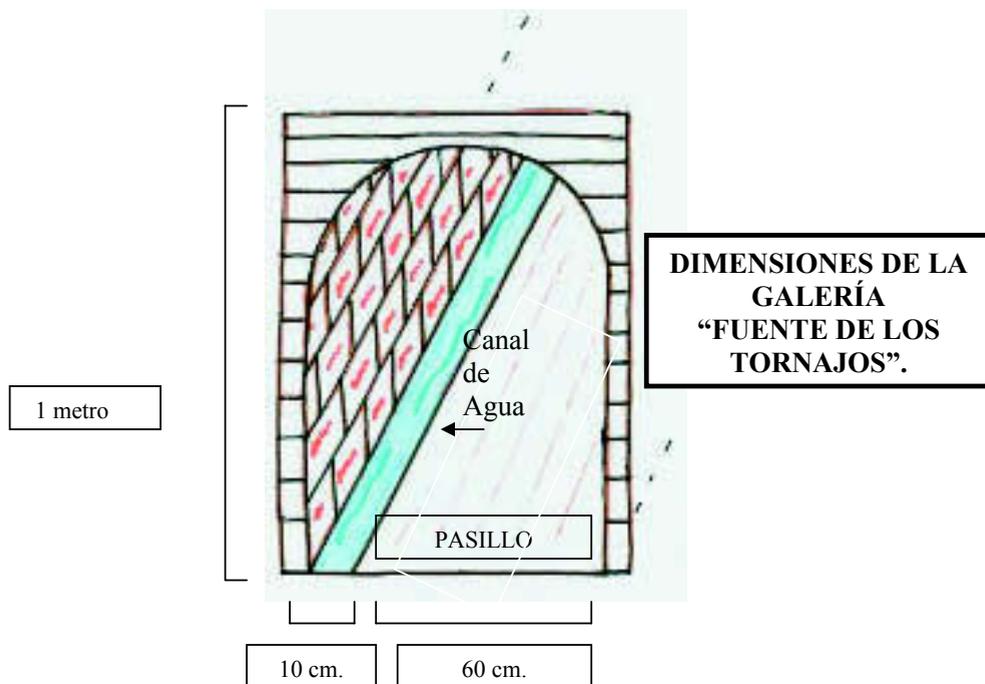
Dimensiones de la bocamina de la Fuente de Los Tornajos.
